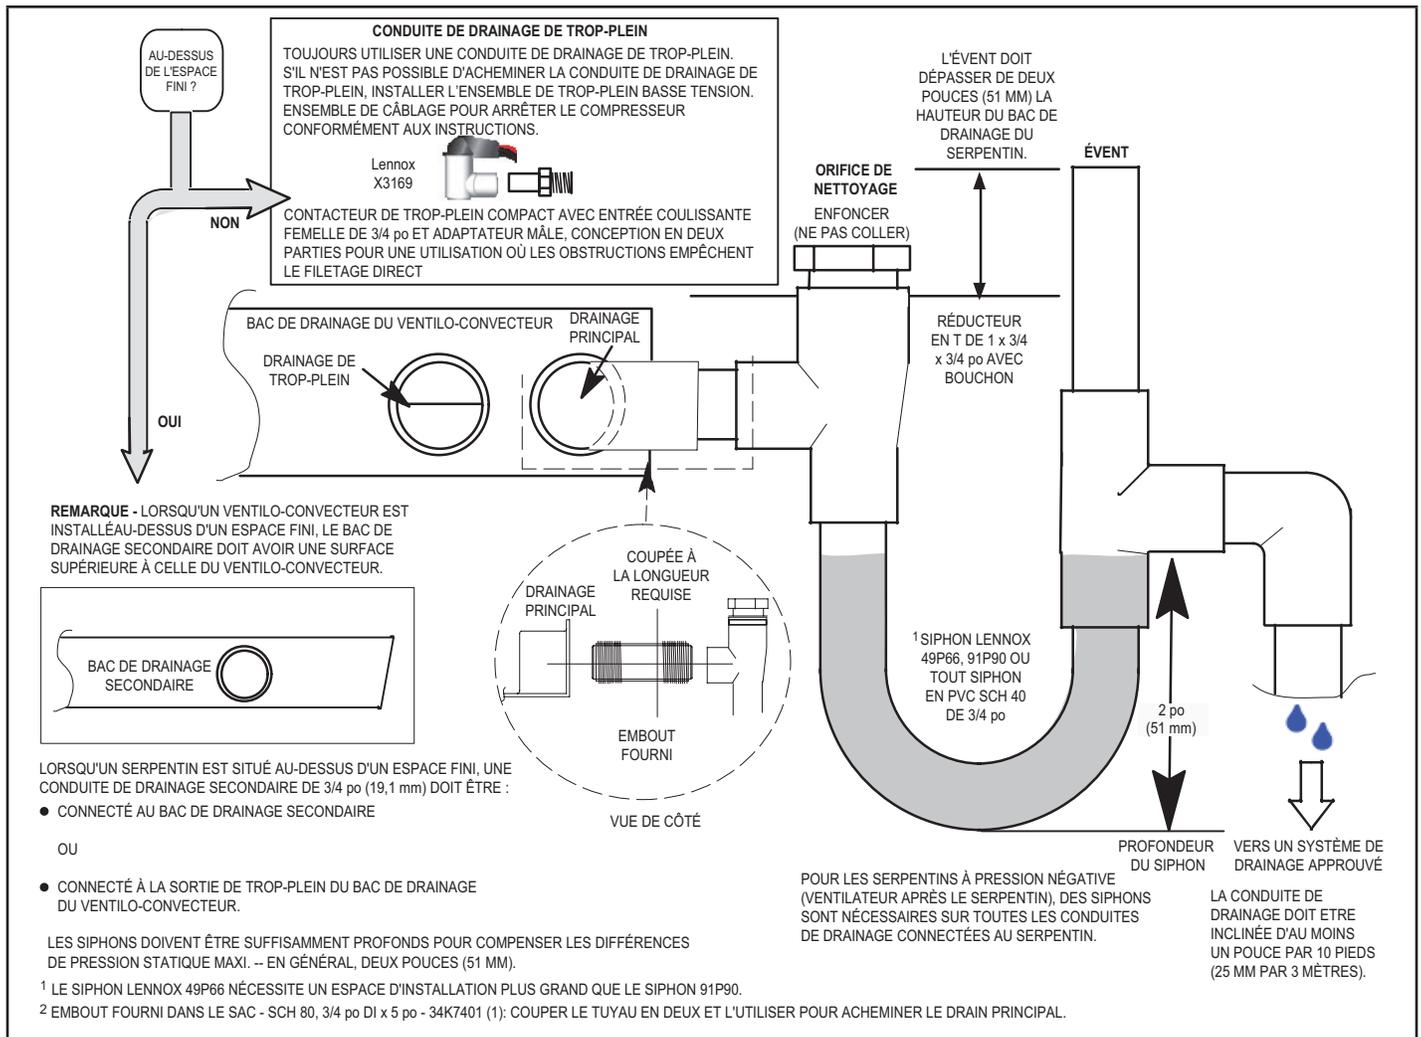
Installations typiques d'un drain principal et d'un drain de trop-plein
